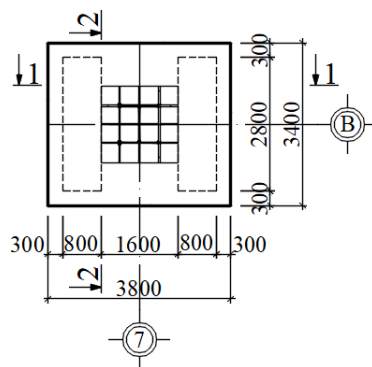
Расчетная схема арматуры у сваи с пятой
